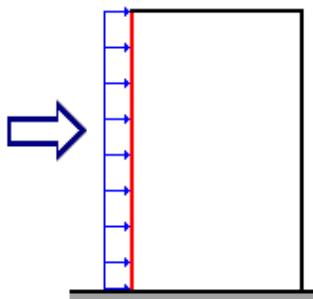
Расчетная схема определения ветровой нагрузки на наветренную поверхность.
